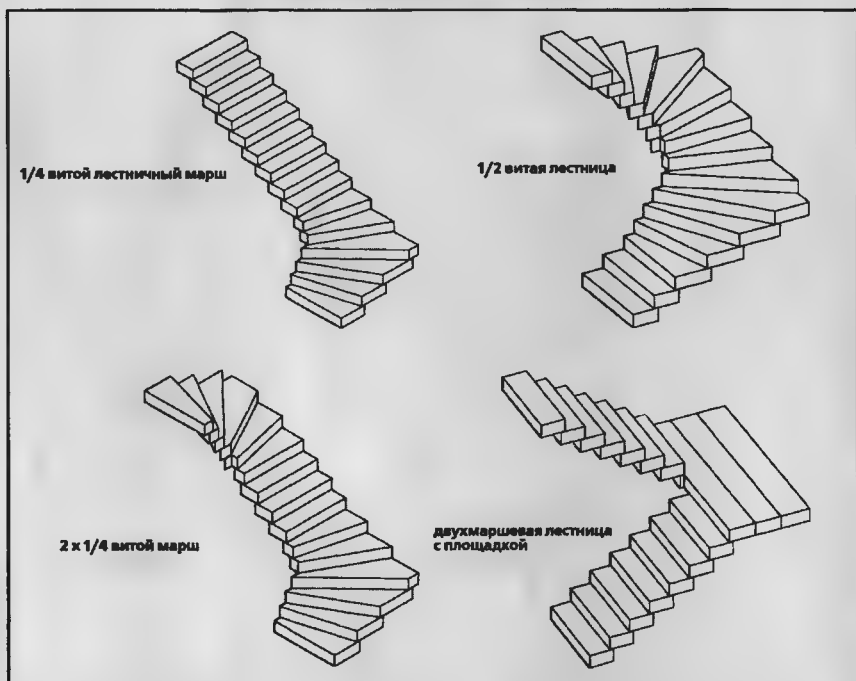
Готовые стандартные ступени для лестницы можно получить со склада или их могут изготовить
